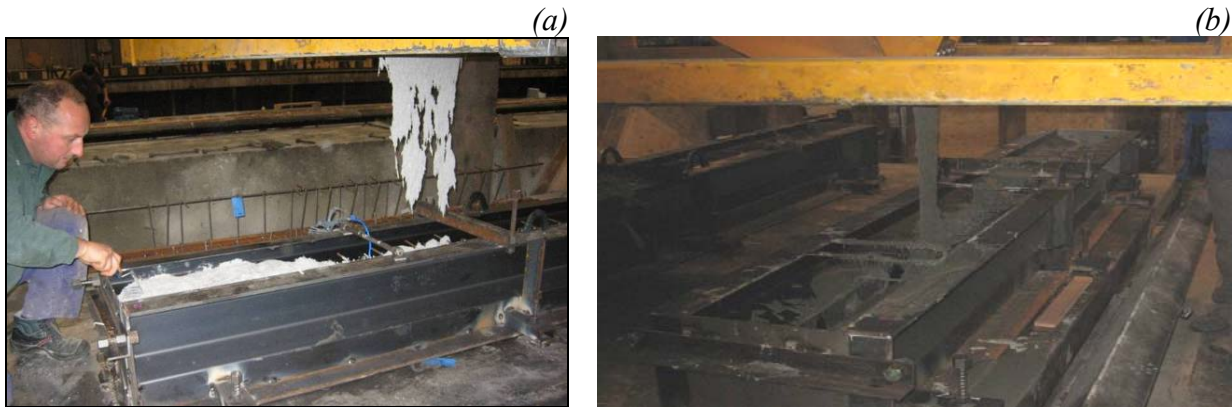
Mise en place du BFUP-B (a) et du BFUP-F (b) pour la configuration : poutre armée longitudinalement et transversalement.
